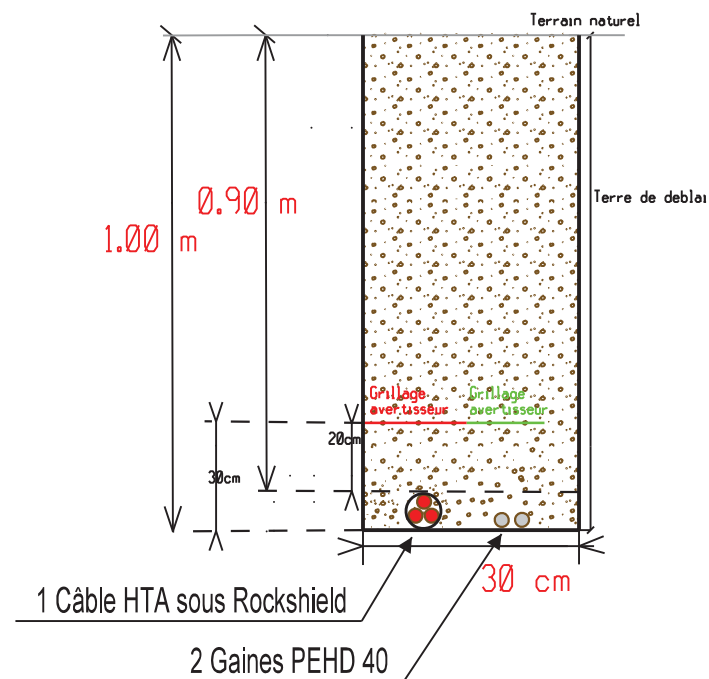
Coupe de câblage - sous accotement voie /chemin (1 câble)
